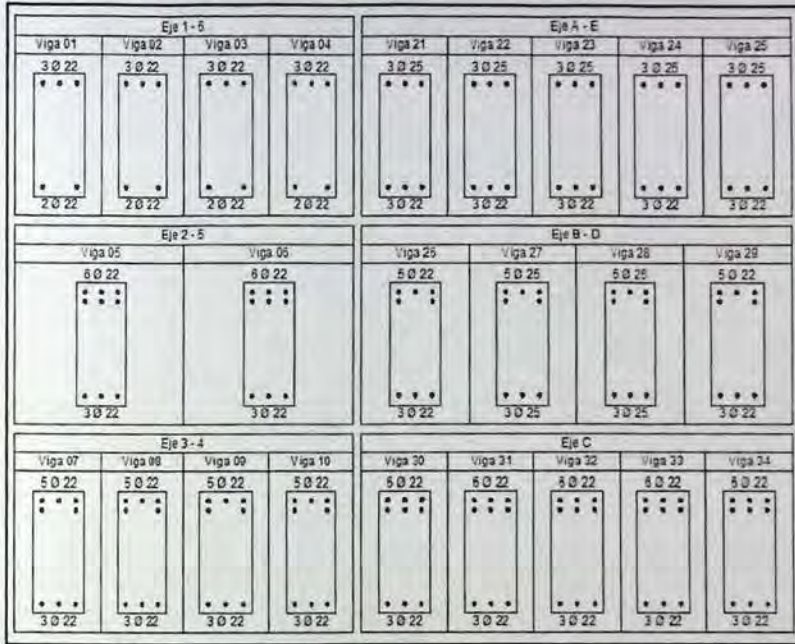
Distribución de refuerzo a flexión en vigas, ejes principales de estructura IV (Nivel 4-15).
